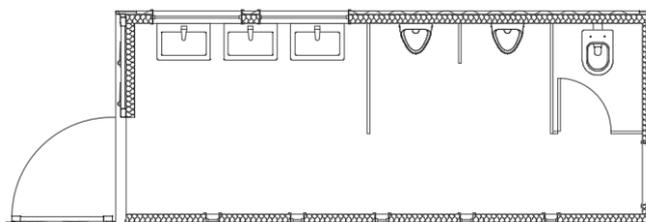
Planta Baixa Módulo 02 - Masculino. Fonte: elaborado pelos autores.
